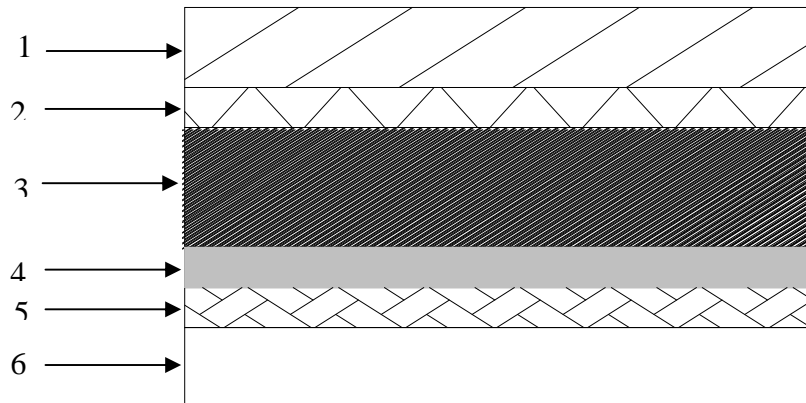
b: Coupe transversale du plancher en corps creux.
